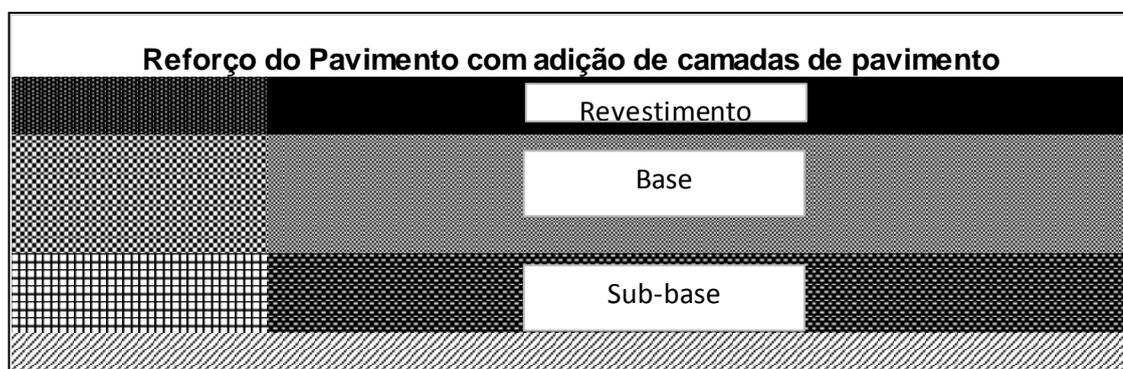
Reforço do pavimento com adição de camadas de pavimento
